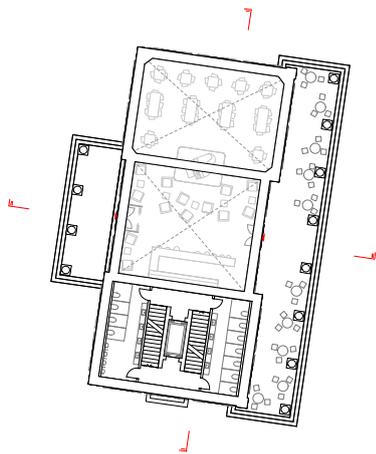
Grundriss 1. Obergeschoss Sommercasino 1:600
